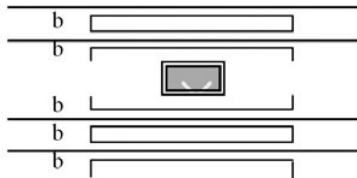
Průjezdná osobní stanice s boční výpravní budovou [8]
